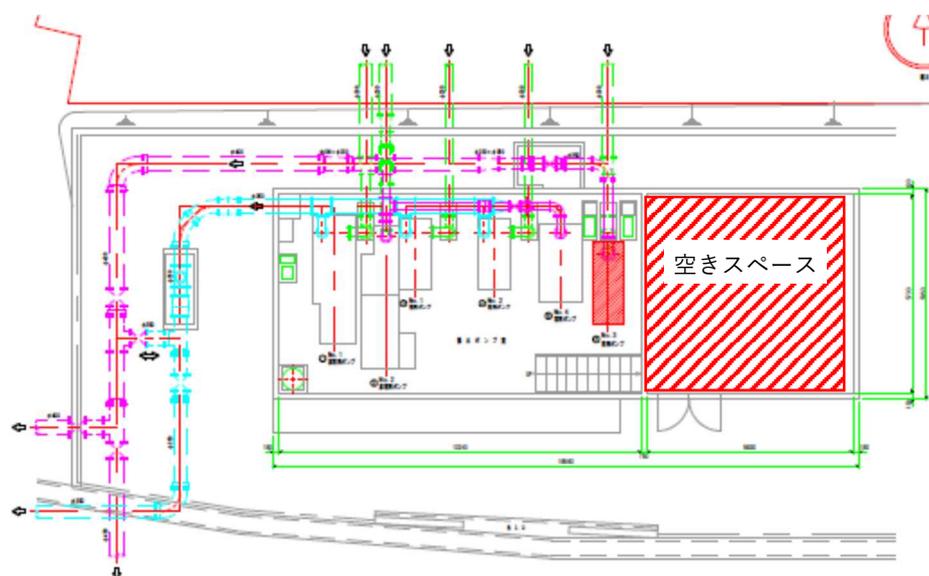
場内平面図（新荘水源・ポンプ棟）
